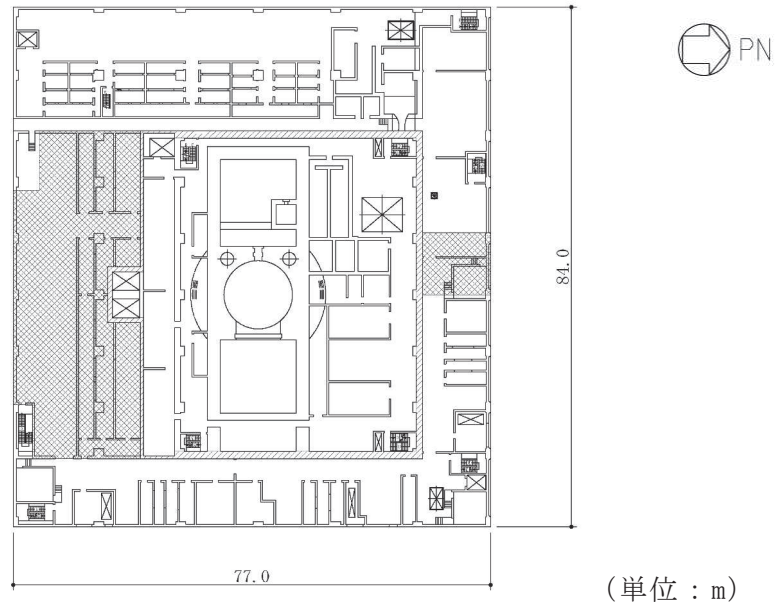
(3) 原子炉建屋原子炉棟（二次格納施設）の範囲の平面図
